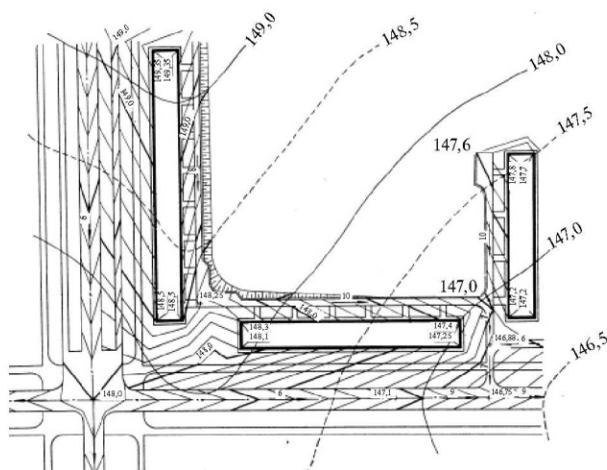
Вертикальная планировка участка жилого градостроительного образования со зданиями, площадками и проездами
